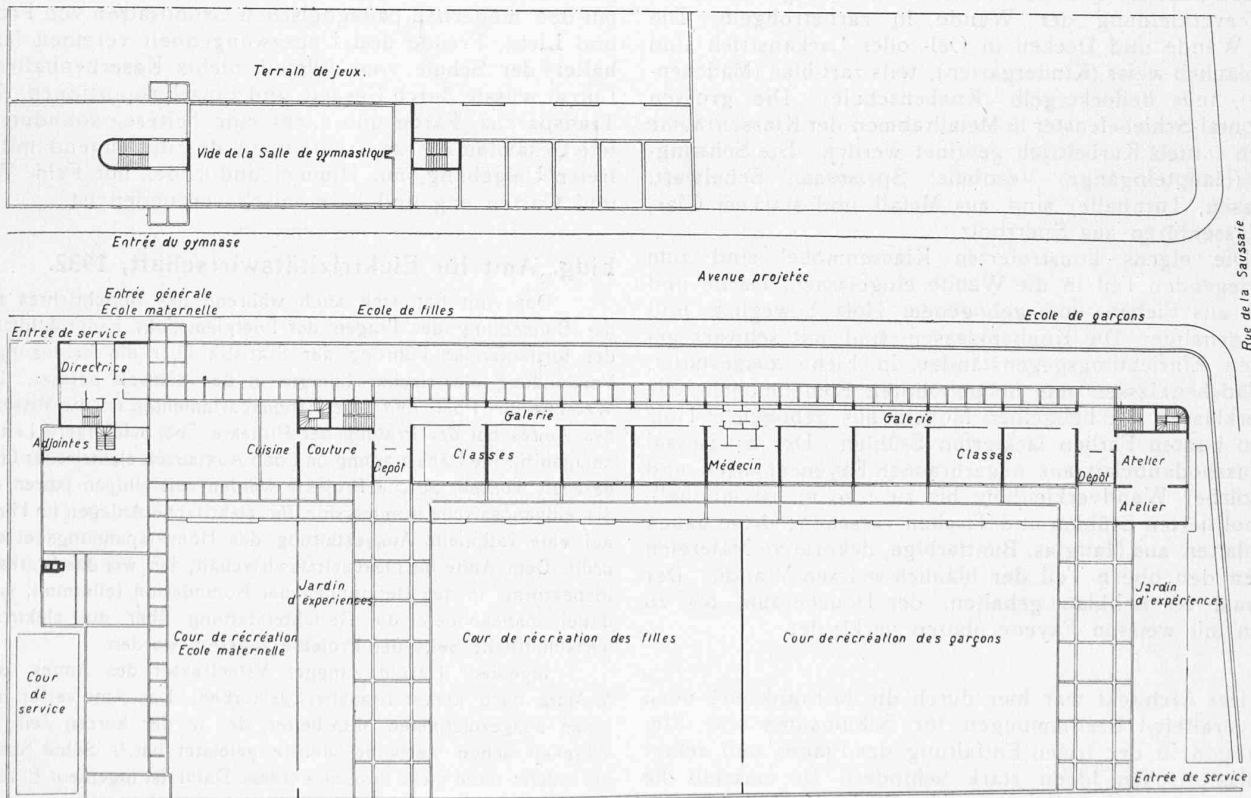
Grundriss des ersten Obergeschosses, 1 : 800. — Orientierung: Norden oben.
